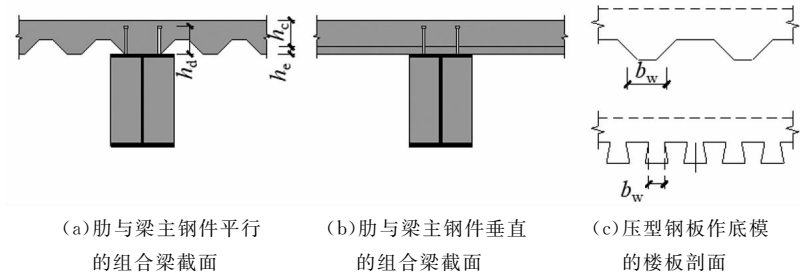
采用压型钢板混凝土组合板做翼板的组合梁示意图
